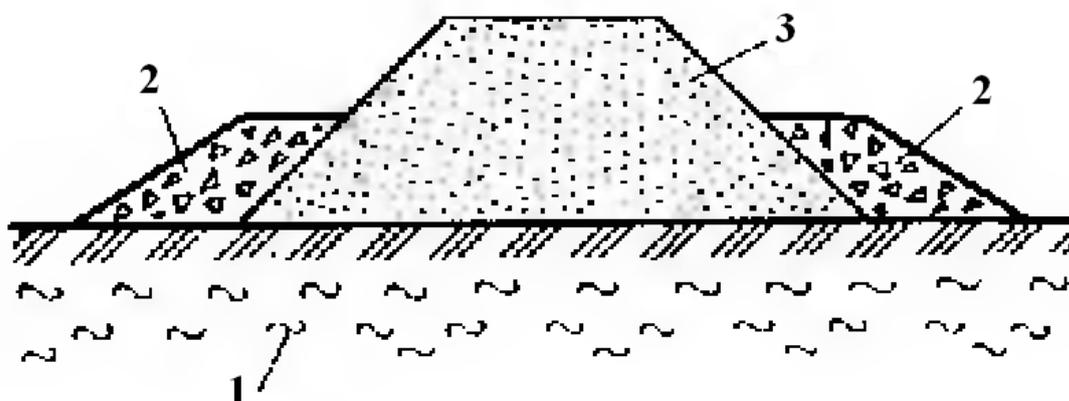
Увеличение устойчивости насыпи на слабых грунтах методом боковой пригрузки: 1 – слабый грунт; 2 – боковая пригрузка; 3 – насыпь
